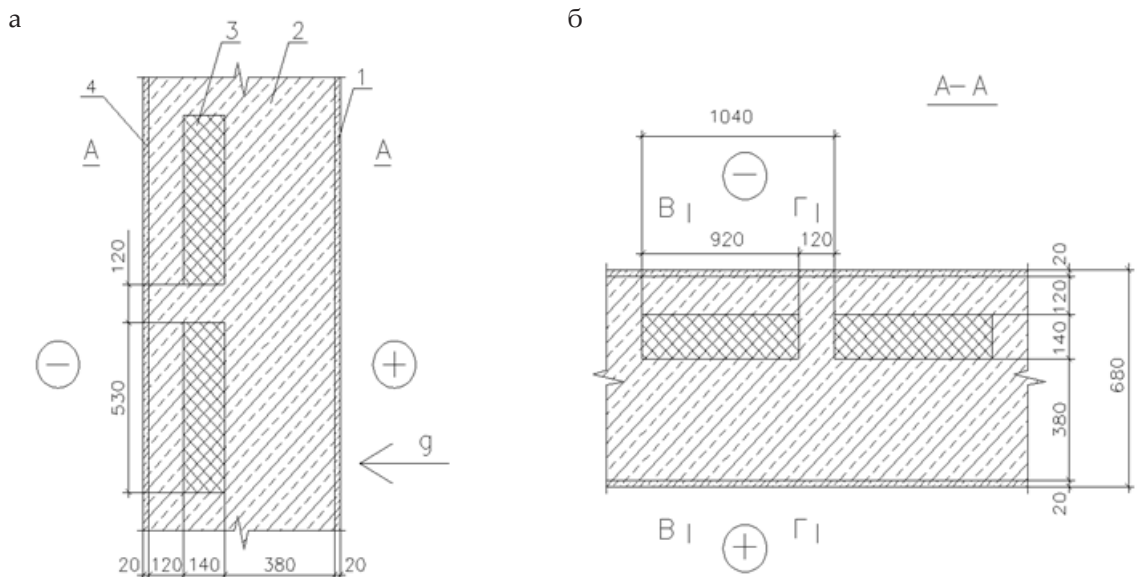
Фрагмент наружной стены: а – сечение по стене; б – план кладки
